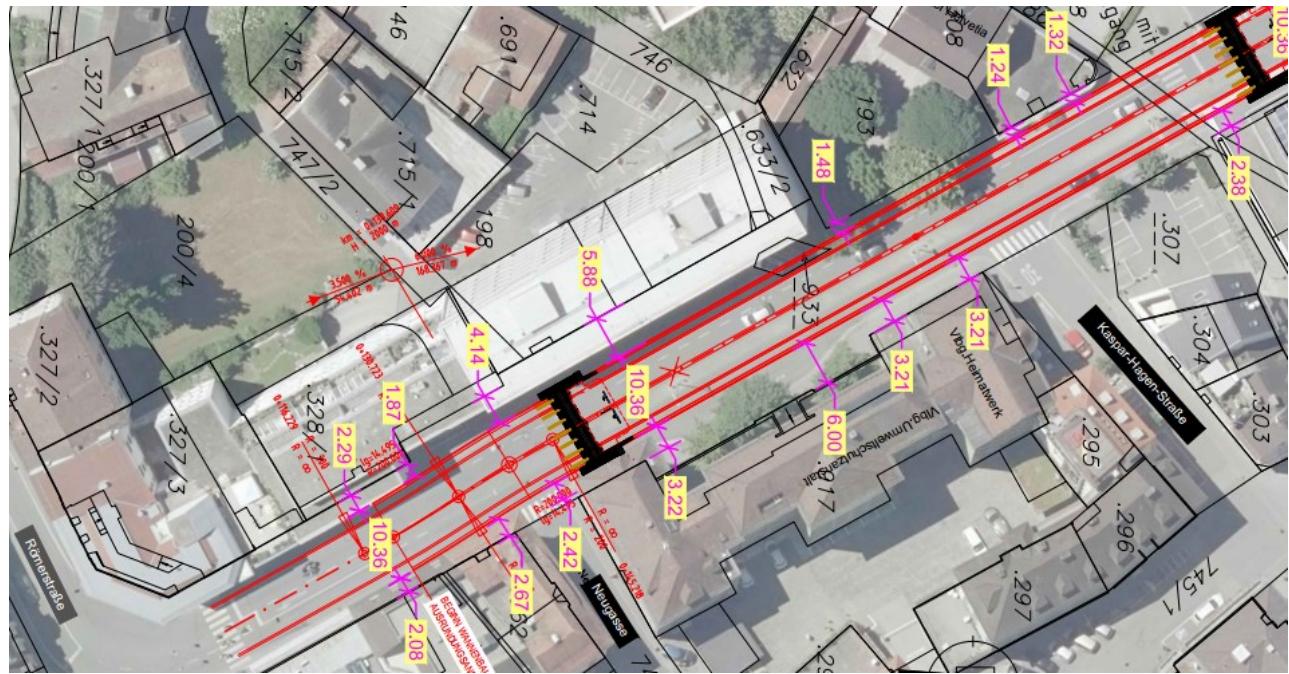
Lageplan Rampe Montfortstraße mit einkotierten Abständen
